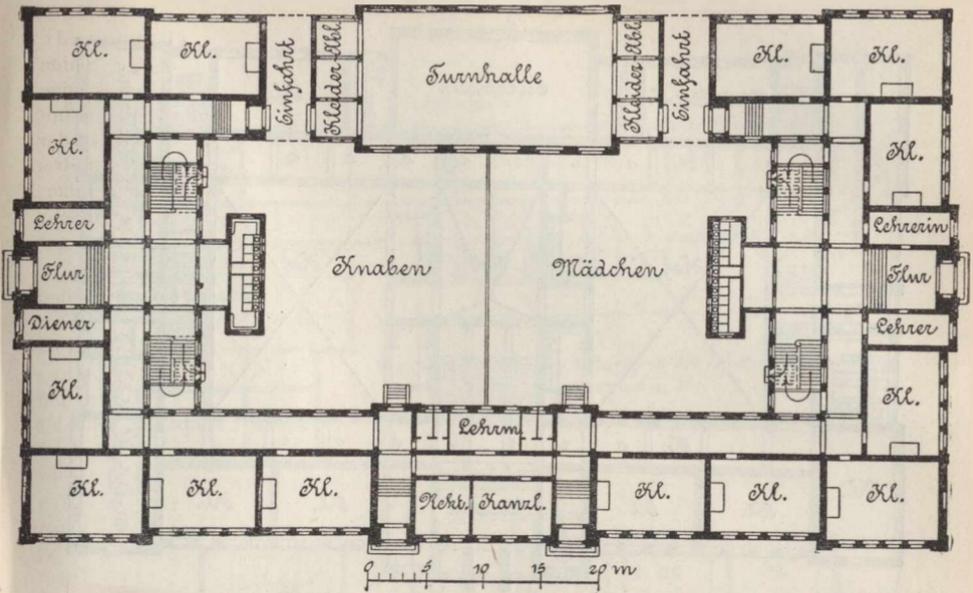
Grundriß vom Erdgeschoß eines Volksschulhauses in Mannheim (s. S. 634).
